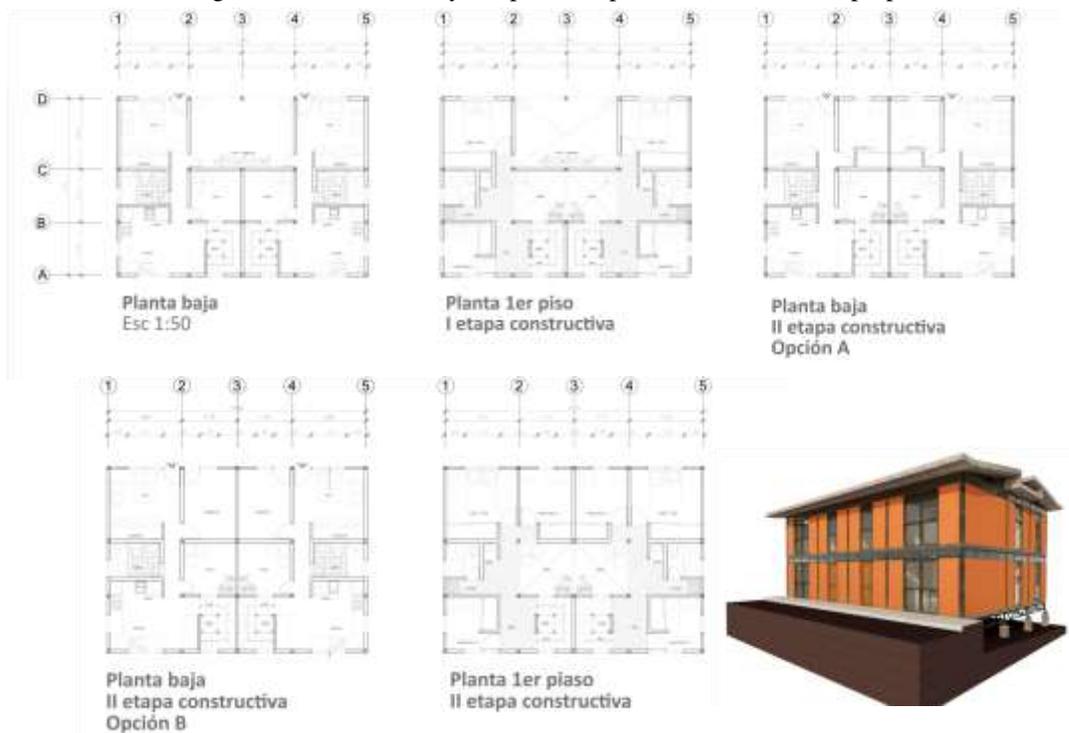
Plantas Propuesta Tipo A. Fuente: Elaboración Propia
